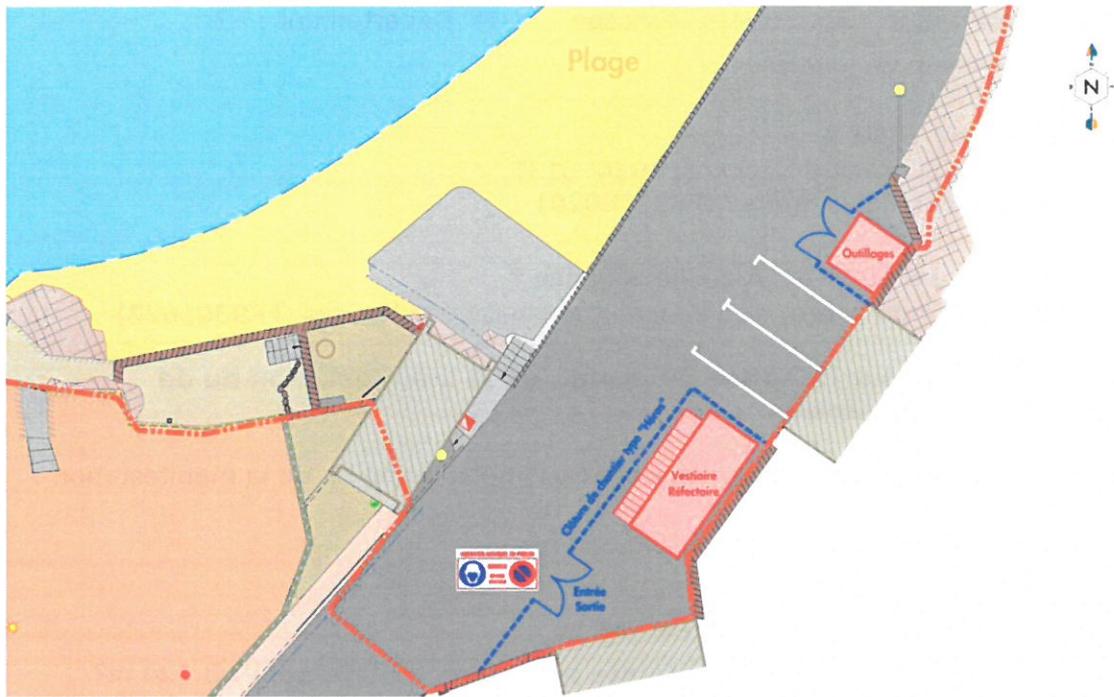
Installations de chantier prévues dans le cadre des travaux
